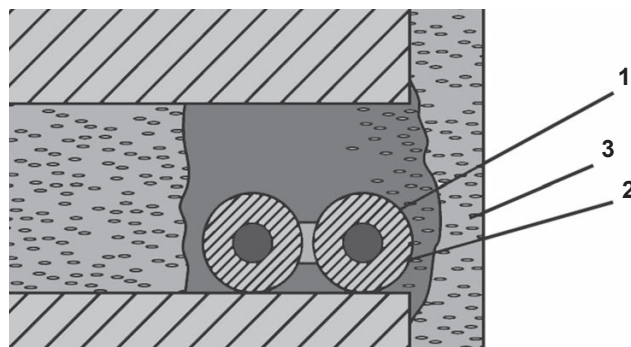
Скрытая электропроводка в кирпичной стене: 1 — провод (черный в середине); 2 — алебастр; 3 — штукатурка мокрая
